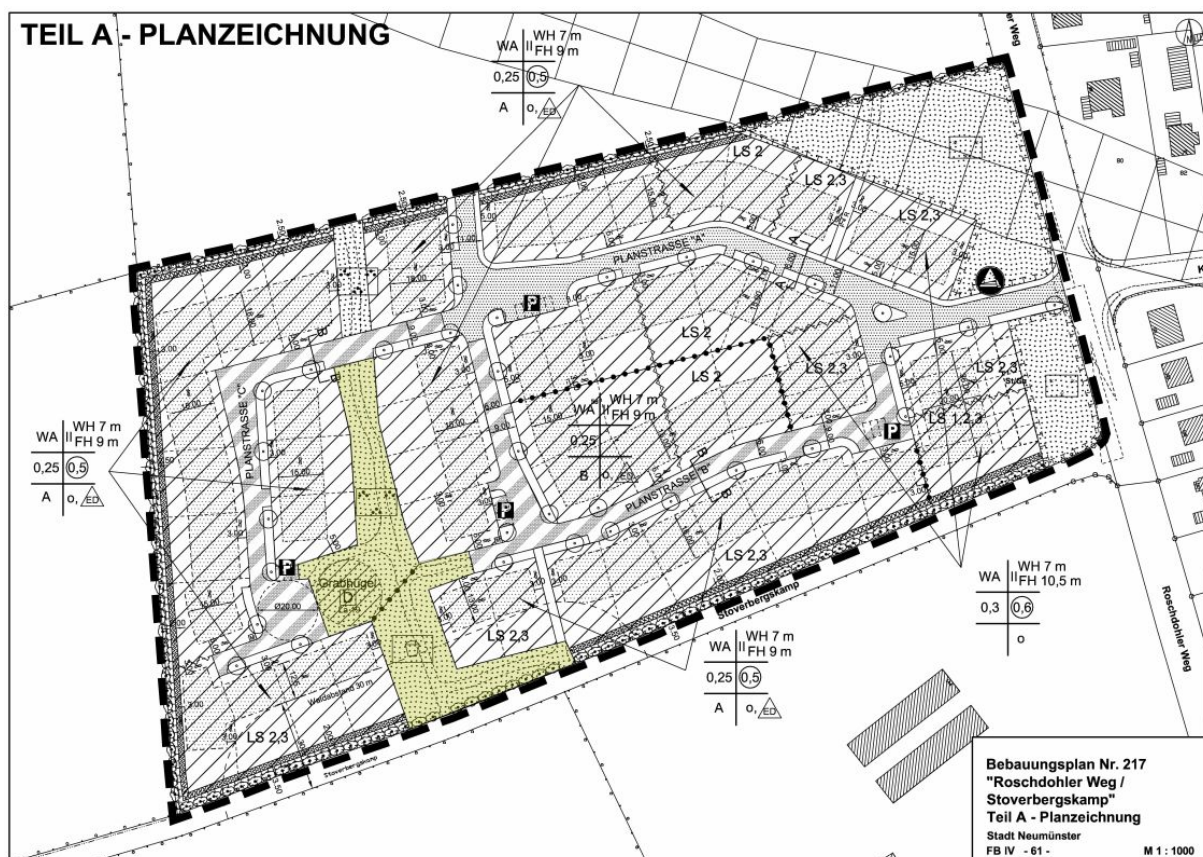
Planzeichnung des B-Planes Nr. 217 mit Kennzeichnung der von der Planänderung erfassten Grünfläche
